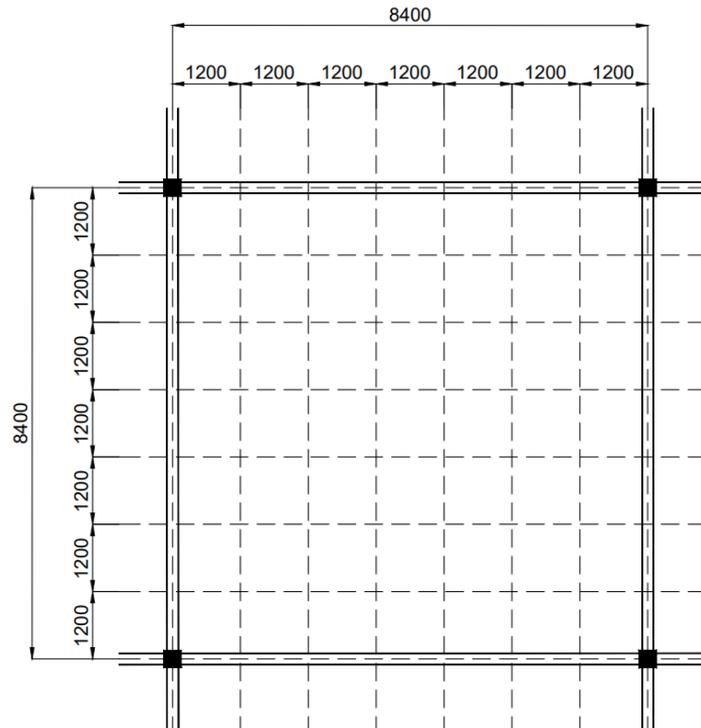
Esquema de modulação dos pilares (dimensões em mm).
